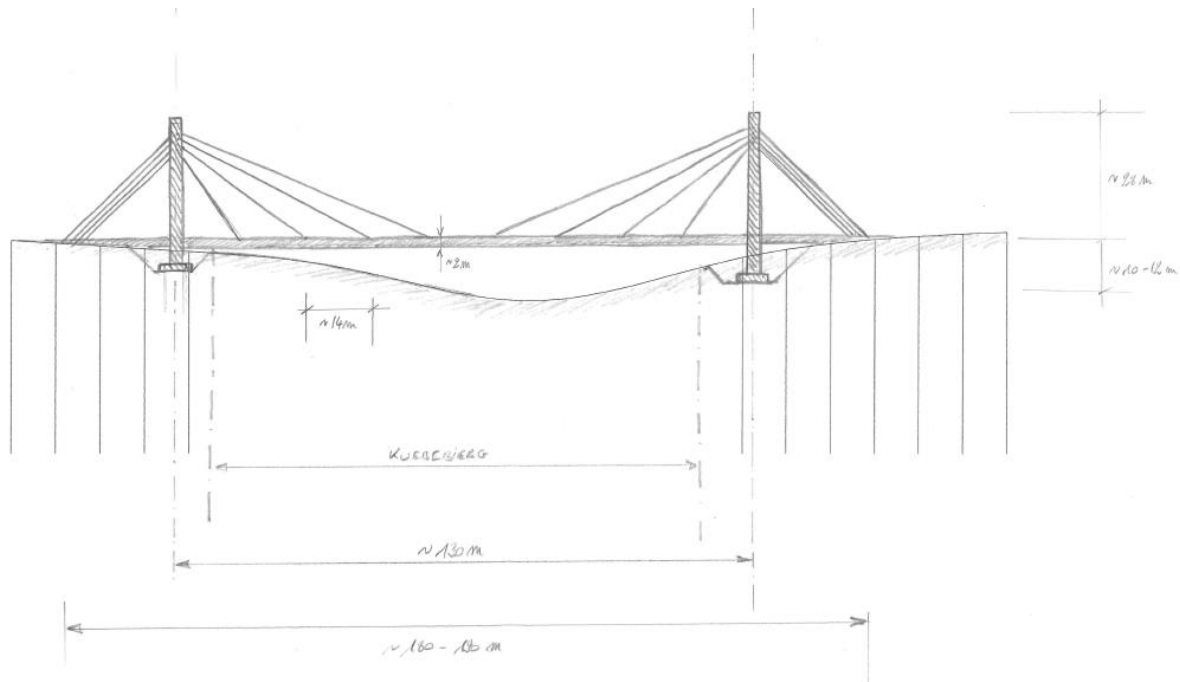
Brückenbauwerk über den Märtesgrond¹³: Variante 1 – Skizzenhafte Darstellung der möglichen Gestaltung der Brücke mit Schrägseilen. Einzige Variante mit der Ausführung sämtlicher Baumaßnahmen außerhalb des Märtesgrond und damit außerhalb des Schutzgebietes (Quelle: Simon-Christiansen & Associés 2017).
